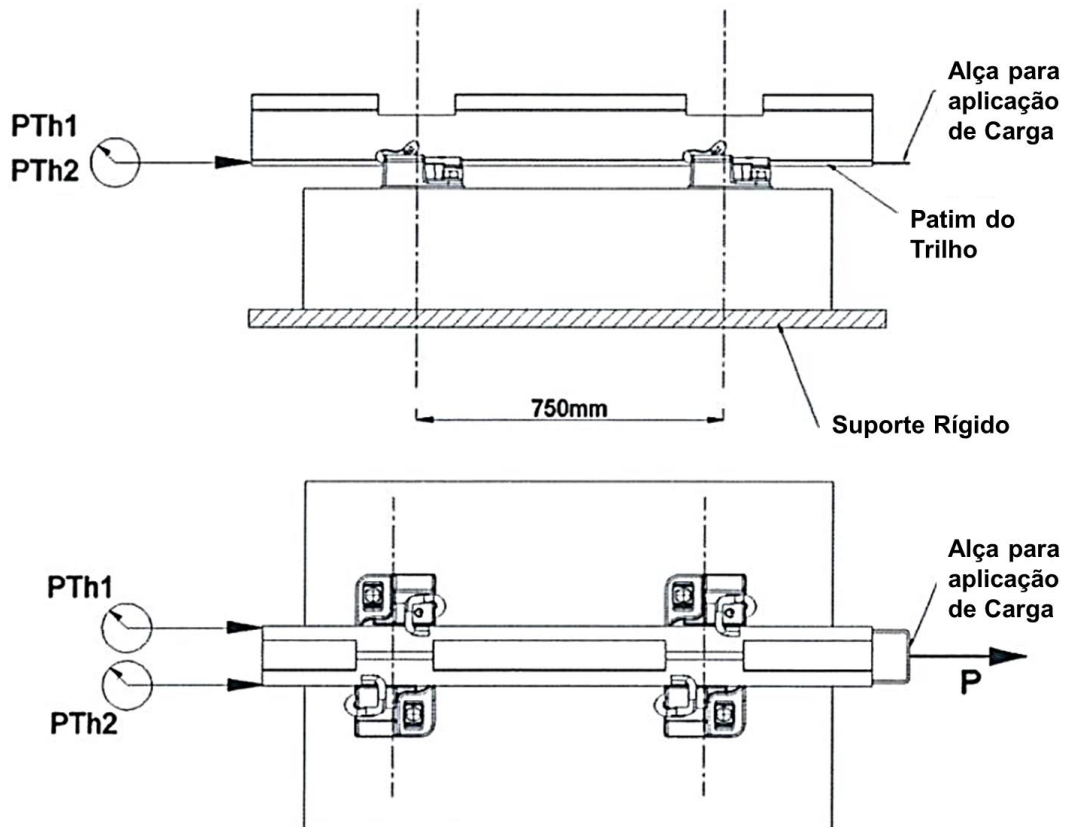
Configuração do Ensaio de Retenção Longitudinal da Fixação
